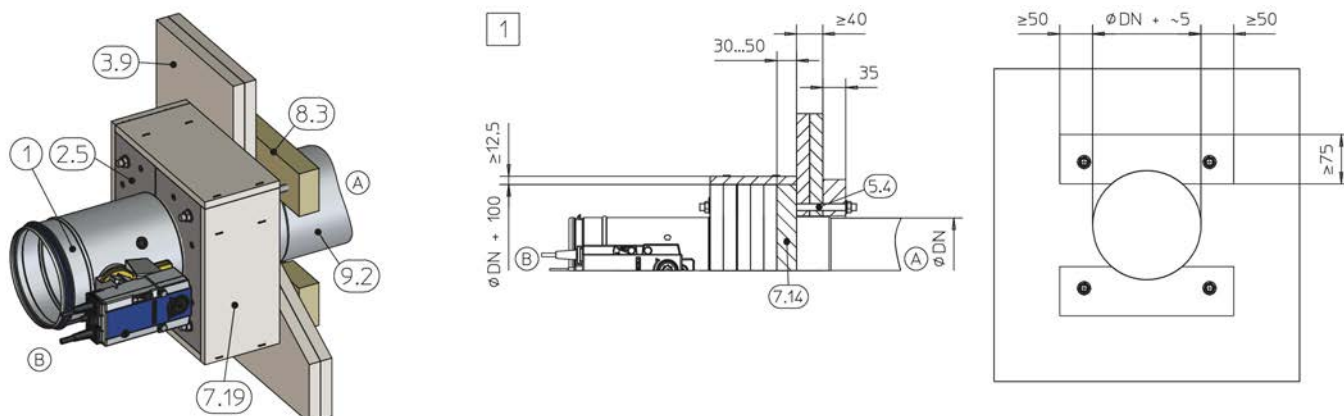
Installazione a secco senza malta con kit di installazione TQ / TQ2 in una parete cava senza struttura metallica di supporto
